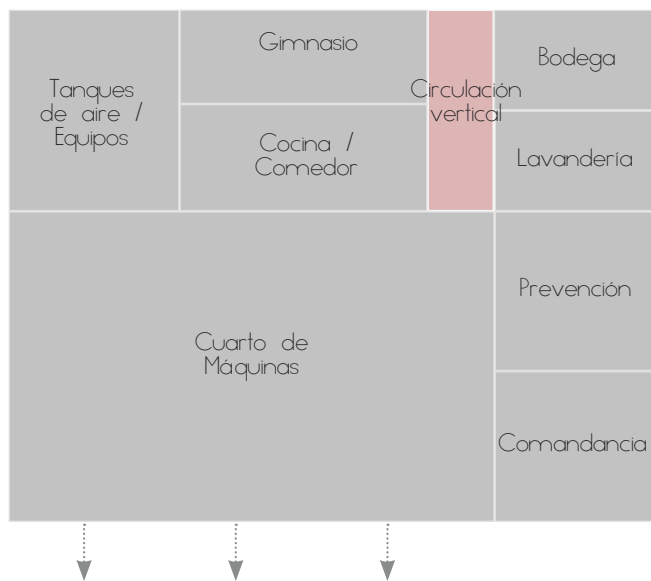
Zonificación planta baja estación N°4 (Autoras, 2019)
